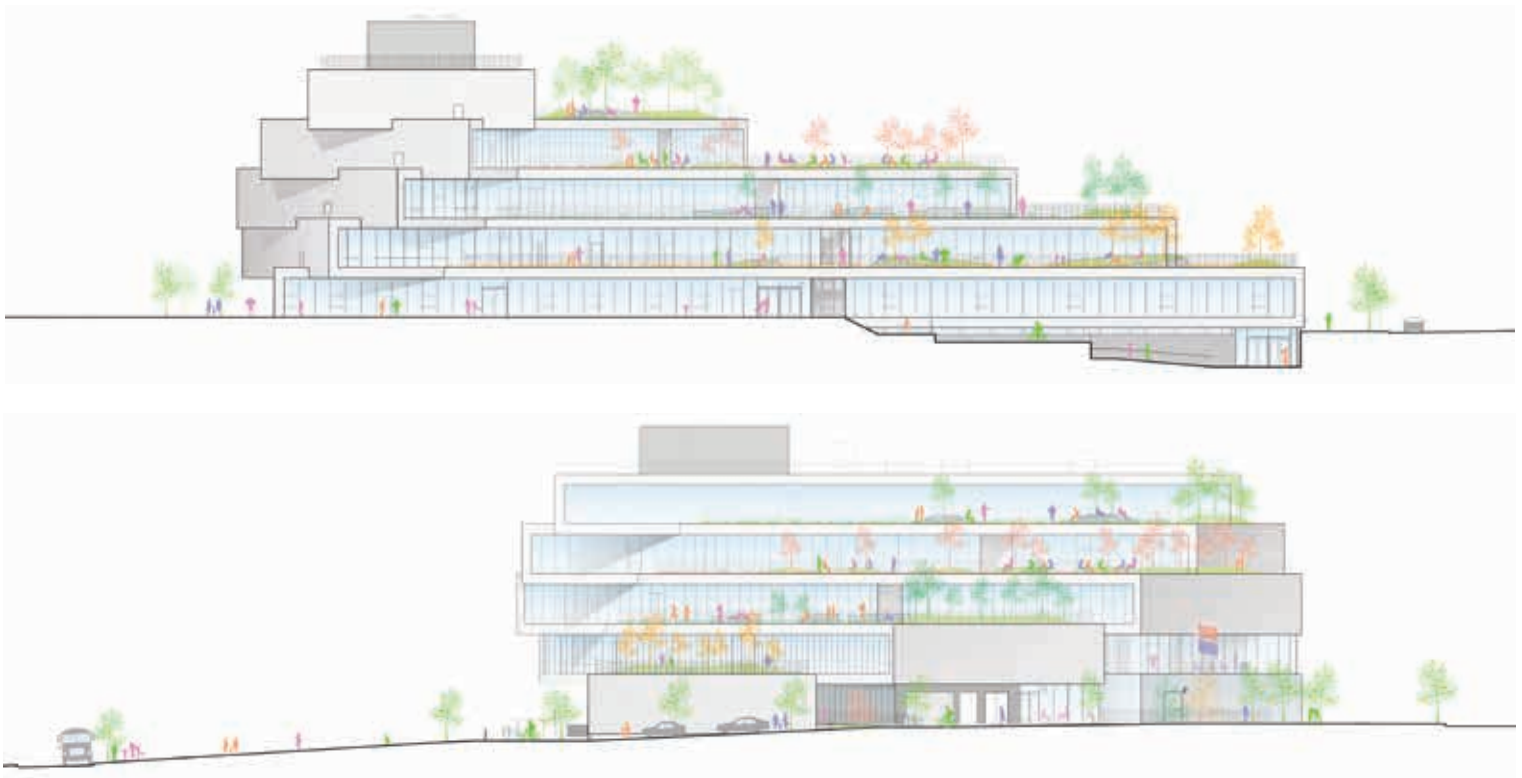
| Prospetto Nord e prospetto Ovest dell'edificio The Heights (© BIG_WILS).
